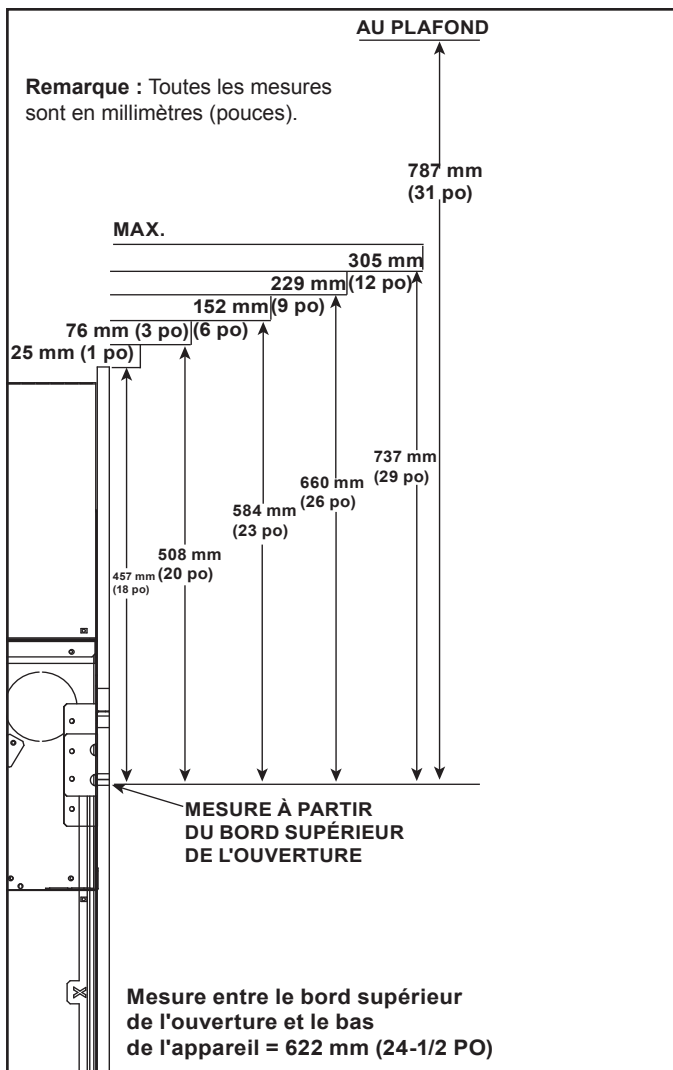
Minimum vertical et maximum horizontal Dimensions par rapport aux matériaux inflammables - CRAVE4836-B et CRAVE6048-B
